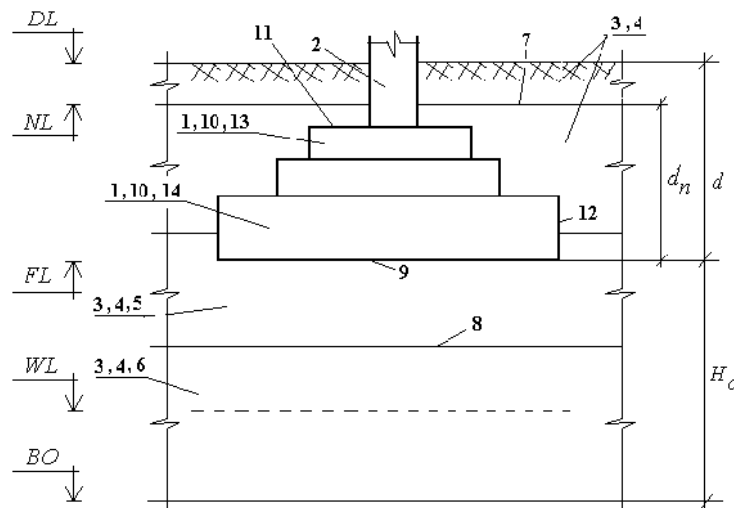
Система «основа - фундамент неглибокого закладення - надфундаментна будова» (схема): 1 - фундамент; 2 - надфундаментна будова; 3 - основа; 4 - ґрунтові шари; 5 - несучий шар ґрунту; 6 - підстиляючий шар ґрунту; 7 - покрівля ґрунтового шару; 8 - підощва ґрунтового шару; 9 - підощва фундаменту; 10 - щаблі фундаменту; 11 - верхній обріз фундаменту; 12 - бічний обріз фундаменту; 13 - верхній щабель фундаменту, 14 - нижній щабель фундаменту; d - глибина закладення підощви фундаменту від рівня планування; d_n - те ж саме, від рівня природного рельєфу; H_c - товщина стисненої товщі; NL - відмітка природного рельєфу; DL - планувальна відмітка; WL - відмітка рівня підземних вод; BO - нижня межа стисненої товщі
